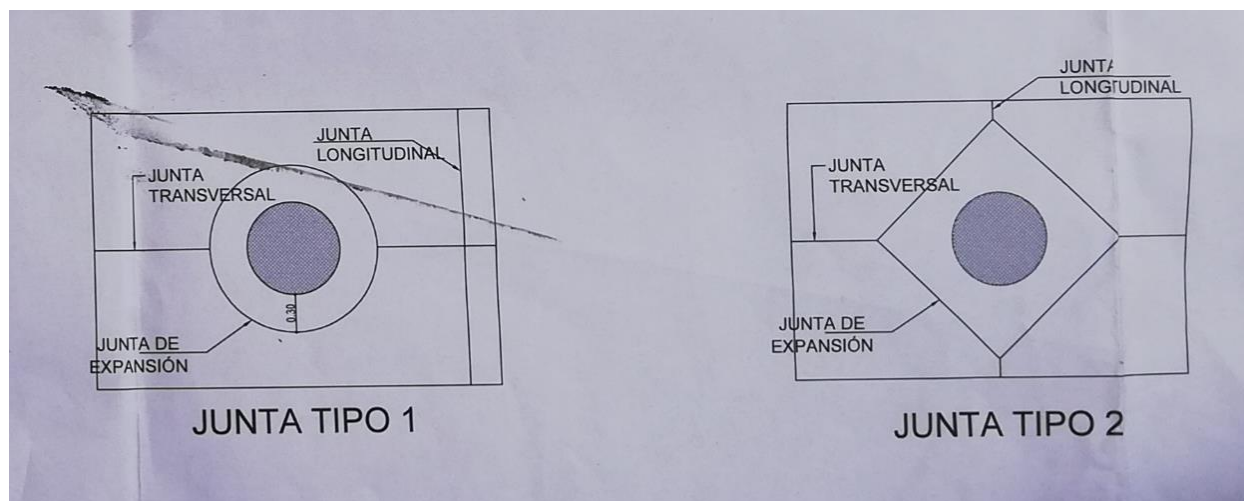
Diseño de juntas para tapas de alcantarillado
